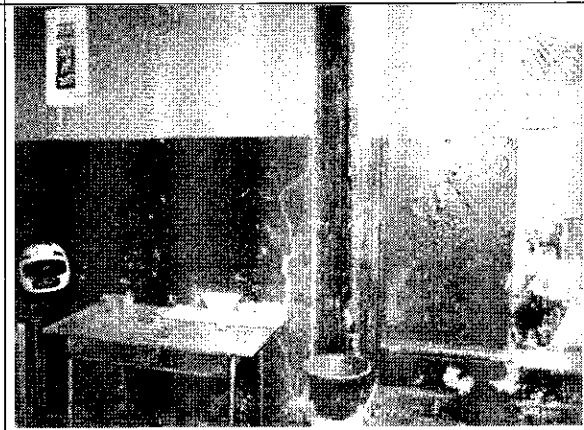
Agrietamiento en muro del pasillo de entrada.
